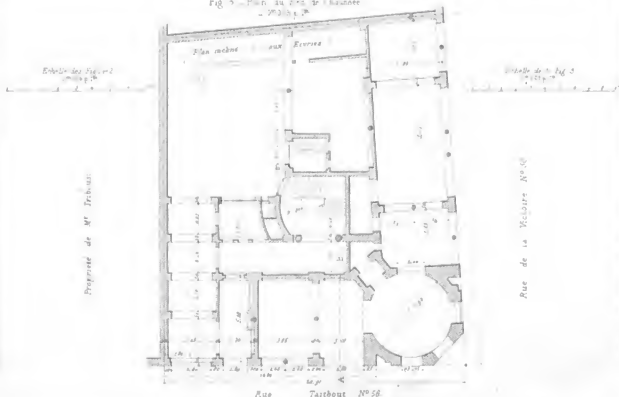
Plan au 1<sup>er</sup> de l'escalier
